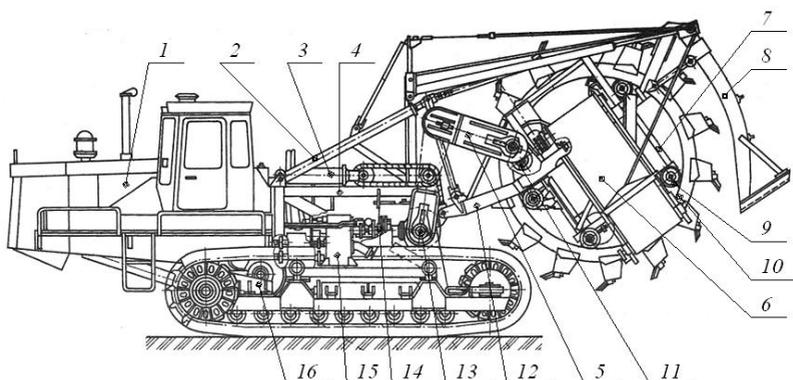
Многоковшовый роторный экскаватор-траншеекопатель ЭТР-204А: 1 – тягач; 2, 3 – механизмы подъема рабочего оборудования; 4 – рама тягача; 5 – шарнирная цепная передача; 6 – конвейер; 7 – рама ротора; 8 – устройство зачистное; 9 – ролики; 10 – ротор; 11 – вал привода; 12 – рабочее оборудование; 14 – муфта предельного момента; 13, 15, 16 – редукторы
